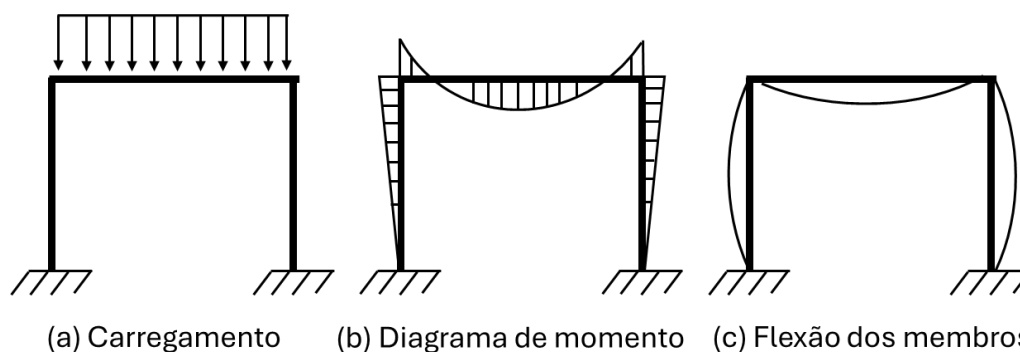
Pórticos plano não contraventado com ligações rígidas (Figueiredo, 2004).
